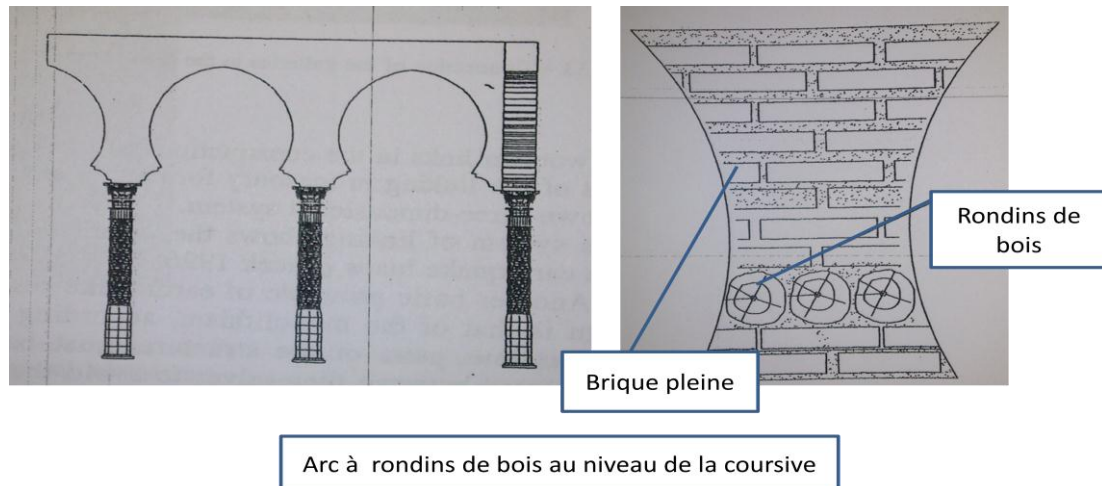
Constitution d'un mur arqué traditionnel [A.Foufa, 2006]
